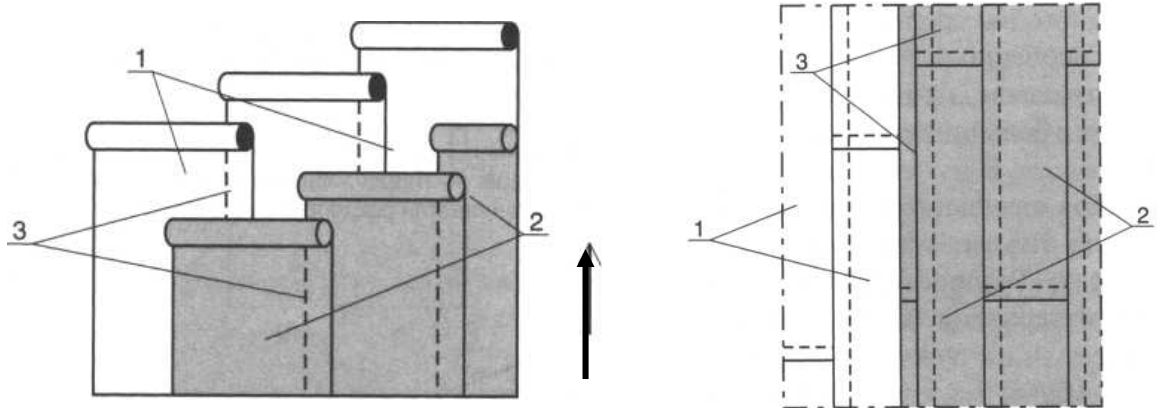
Укладка гидроизоляционного покрытия из рулонных материалов
